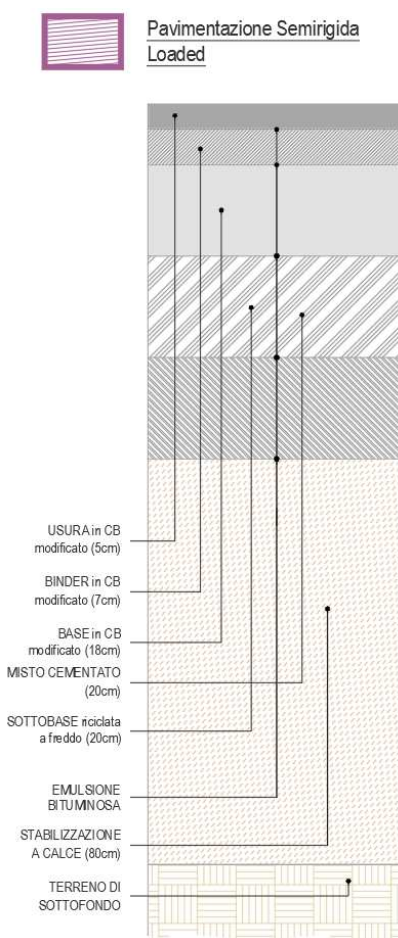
Stratigrafia pavimentazione area loaded nuova "RWY 11-29"
